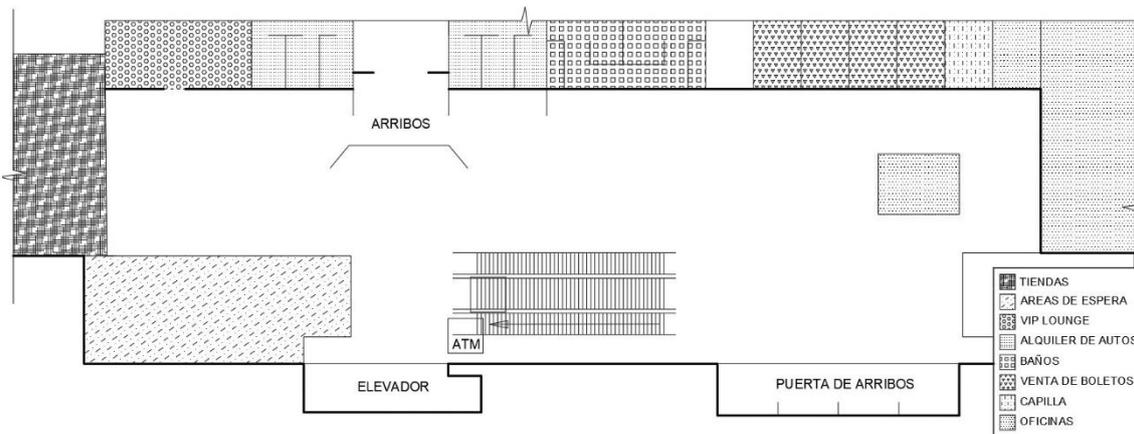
Vista en planta. Vestíbulo de llegadas.
